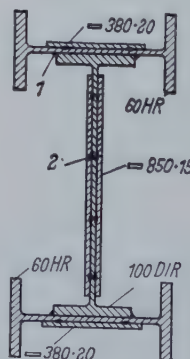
Querschnitt einer Kesselhausstütze (Gewicht 1,235 kg/m)
